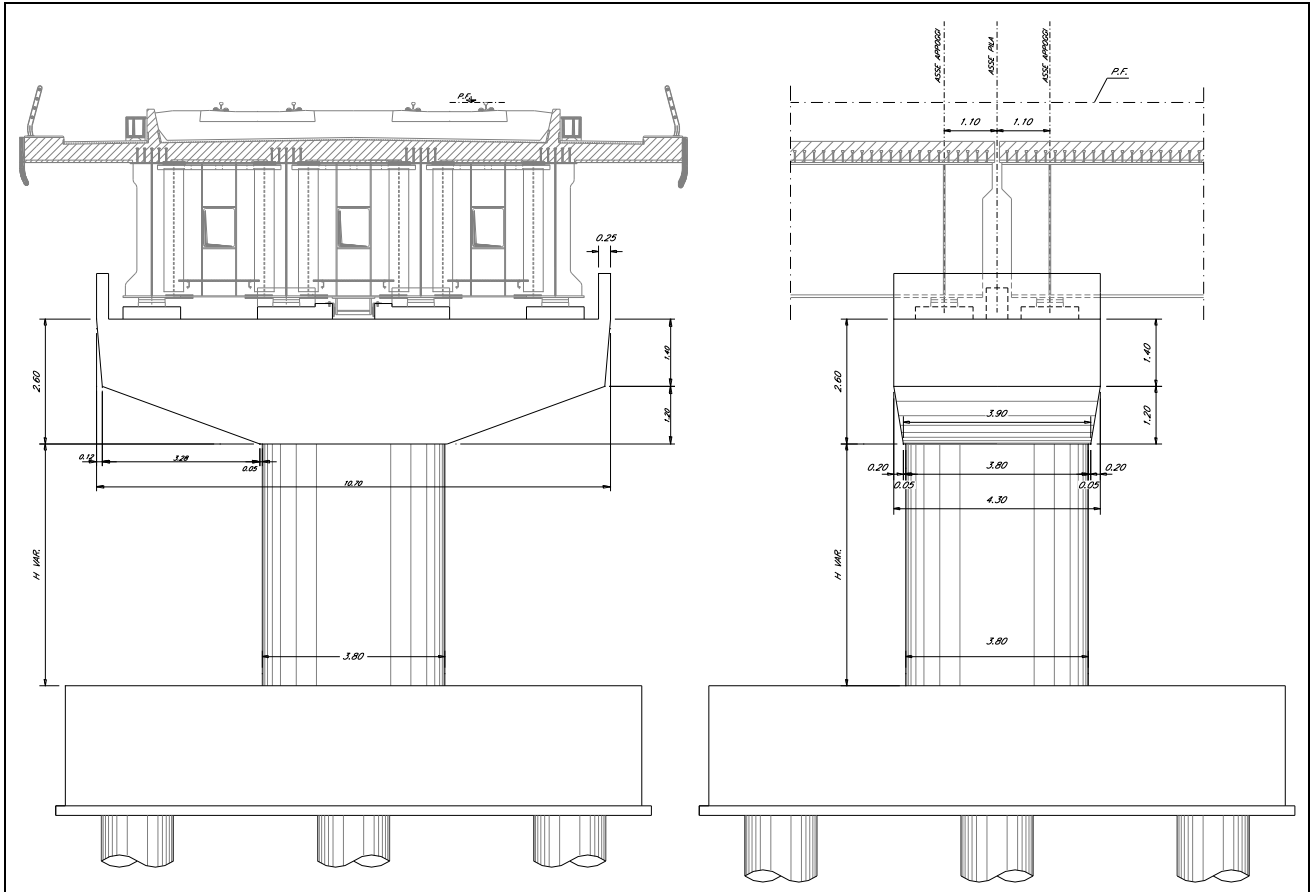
Viste pila con sezione circolare per impalcato L=43.00m
